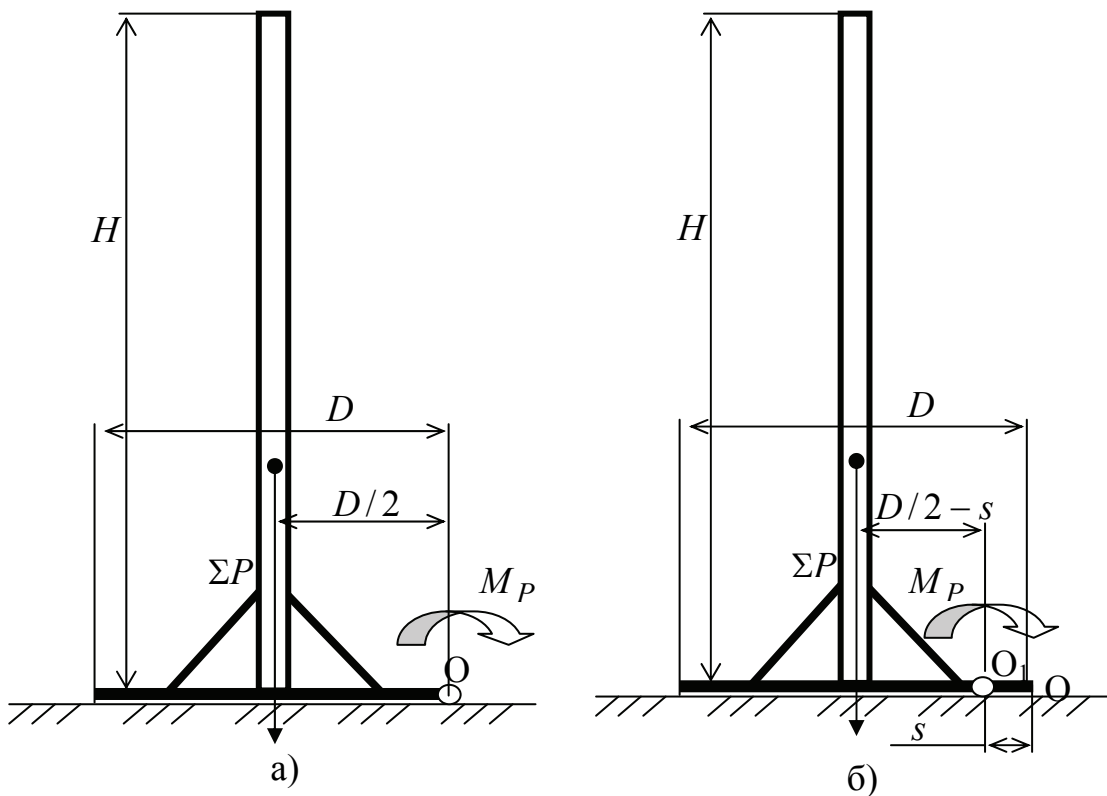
Розрахункова схема безфундаментної вежі на стійкість від перекидання: а – на жорсткій основі; б – на пружному ґрунті
